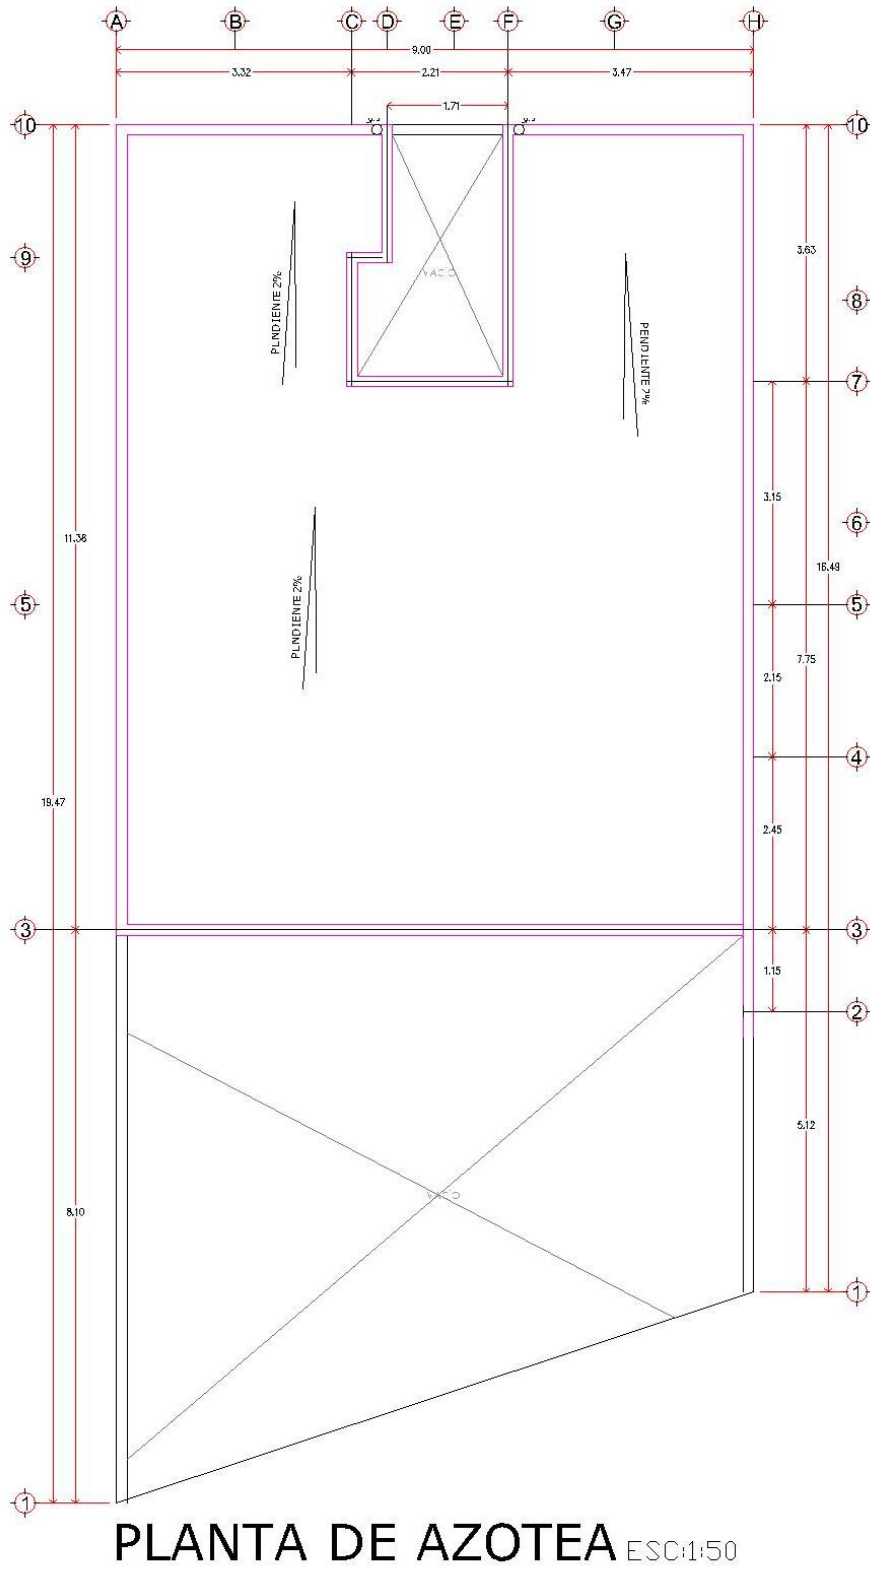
Planta arquitectónica de azotea. Fuente: Análisis y diseño estructural (2021)
